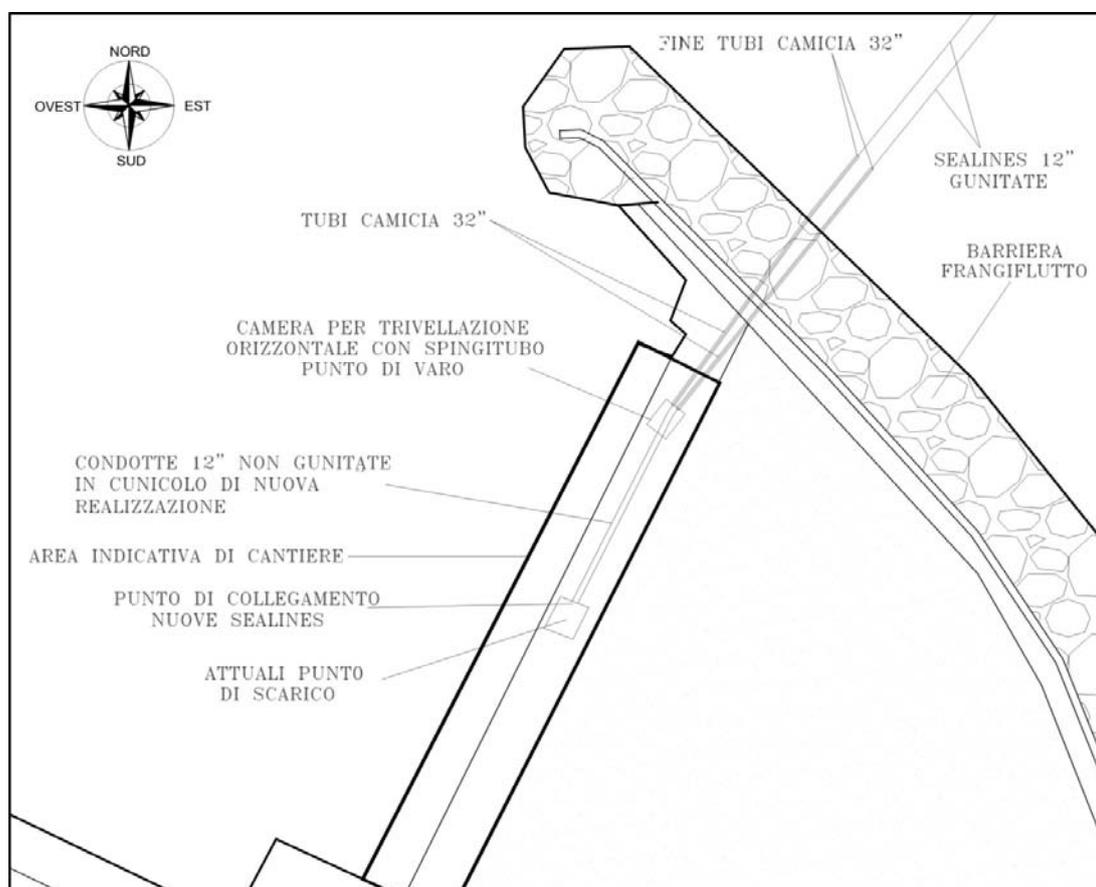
Assetto planimetrico delle modifiche previste nella zona di ormeggio del porto di Pescara
